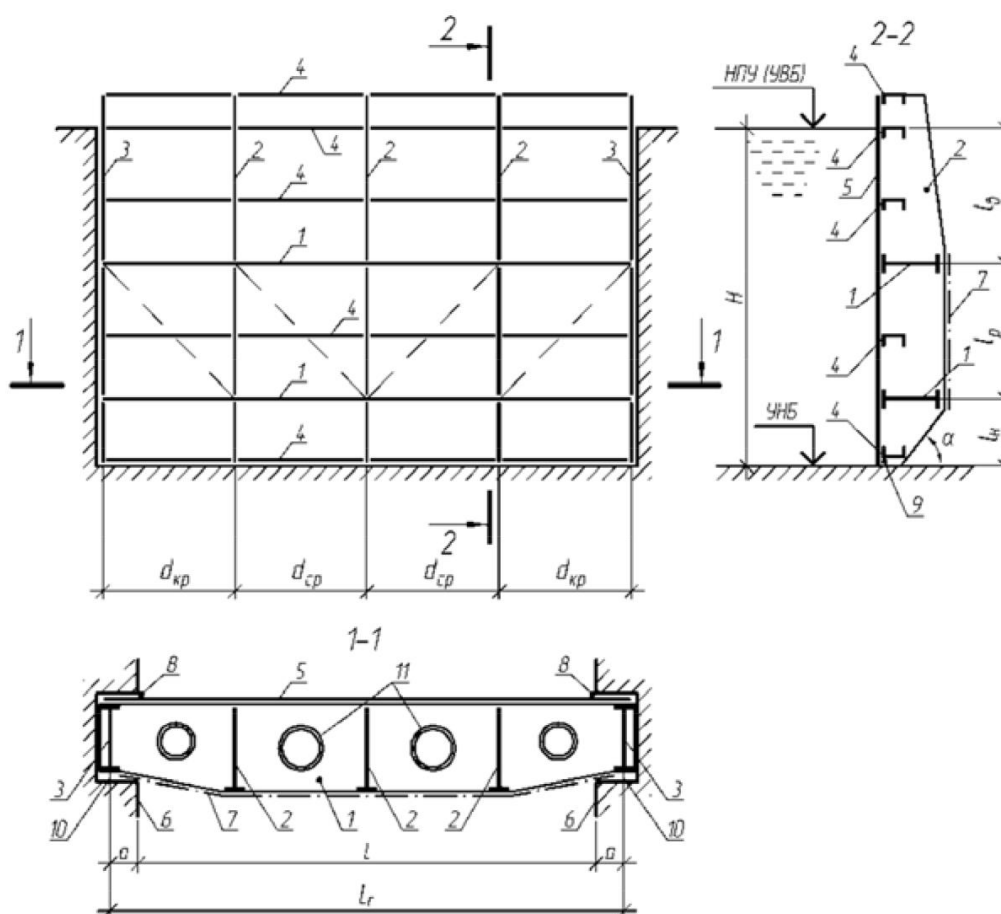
Конструктивная схема плоского затвора: 1 – ригель, 2 – диафрагма, 3 – ОКС, 4 – стрингер, 5 – обшивка, 6 – быки, 7 – ПСФ, 8 – боковое уплотнение, 9 – донное уплотнение, 10 – опорно-ходовое устройство, 11 – отверстие в нижнем ригеле
